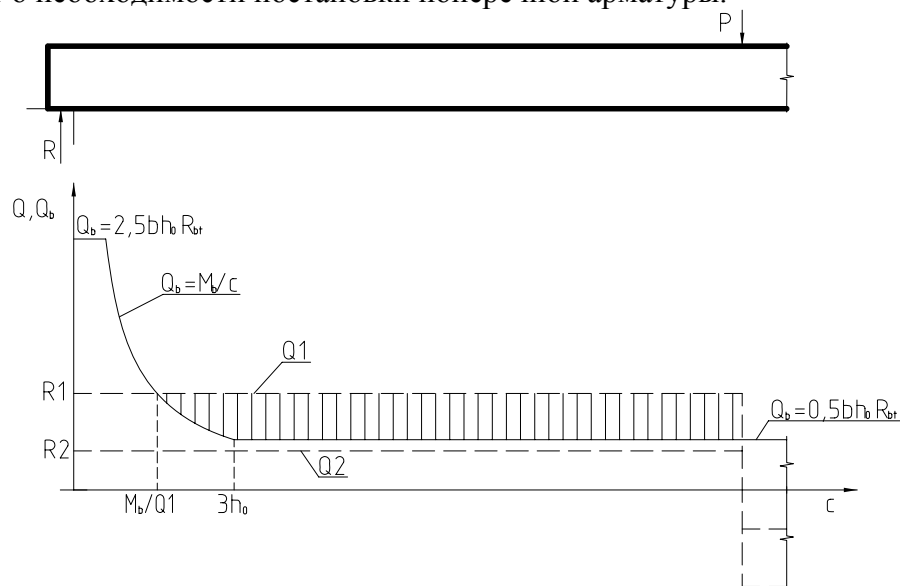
К расчету элементов без поперечной арматуры при постоянной поперечной силе
